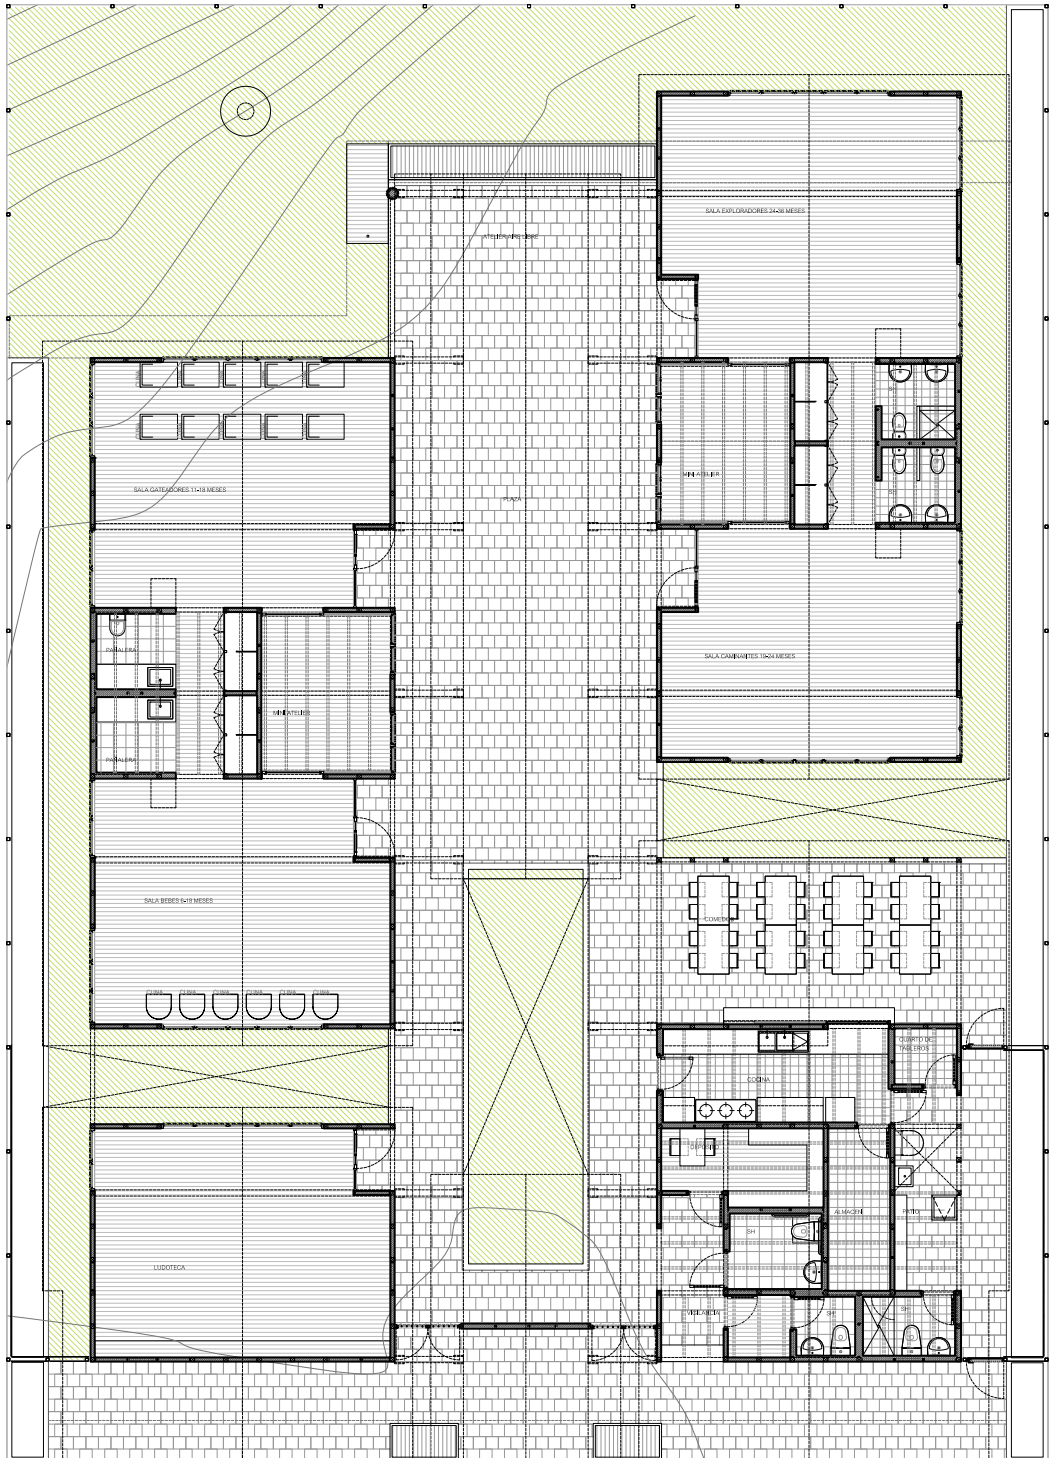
Planta final del primer piso del CIAI Cuna Más.
